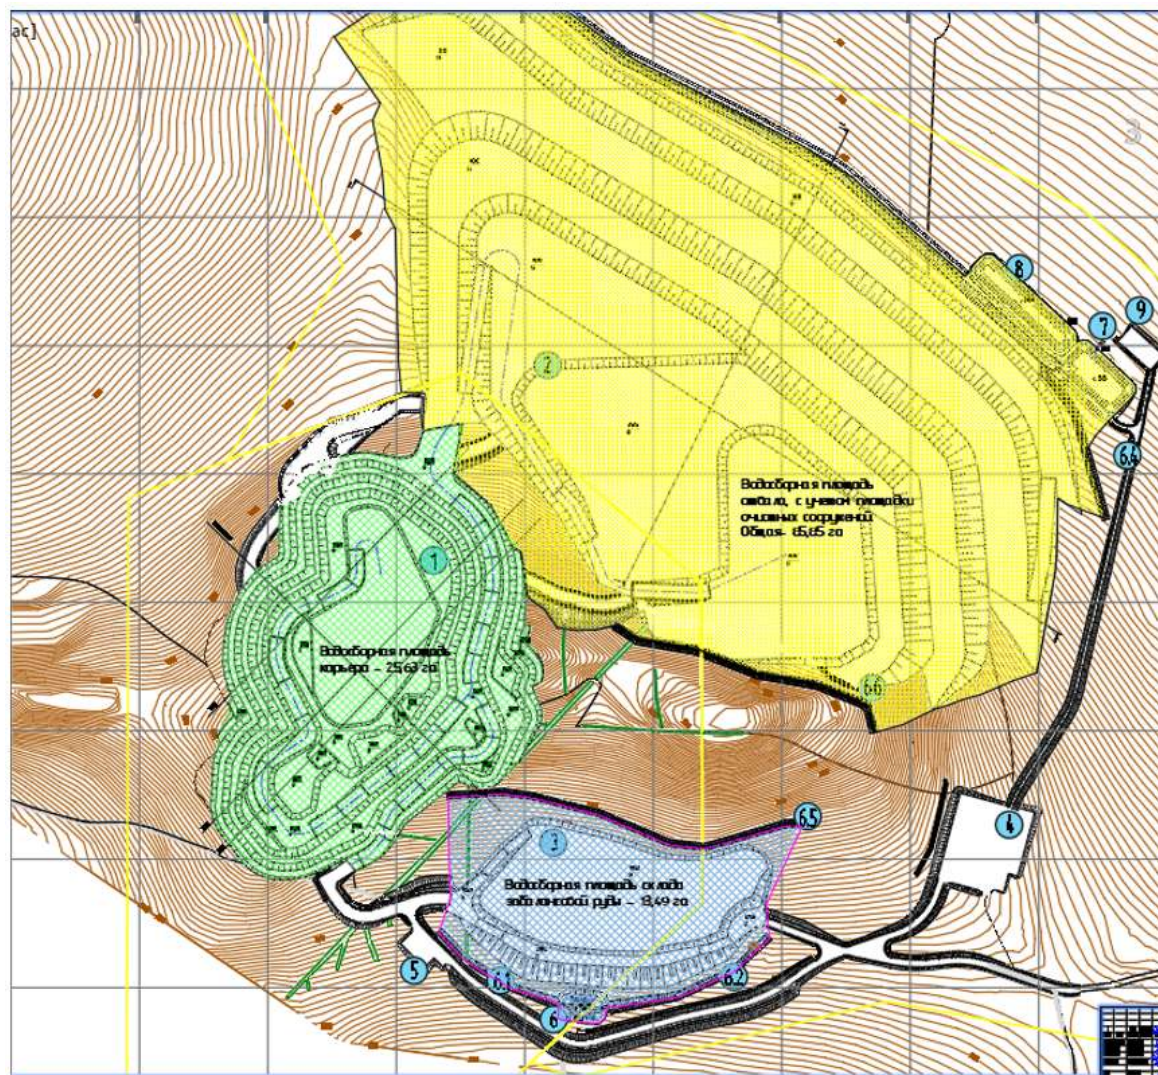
Водосборные площади на 6-9 год отработки
